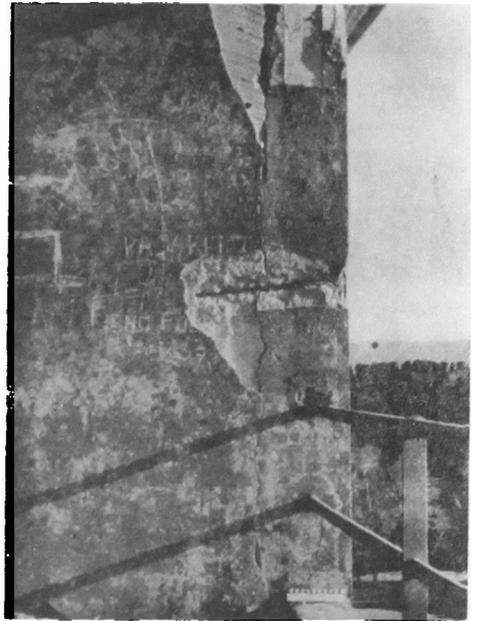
Falla de anclaje en la esquina de dos muros. Terraza, extremo poniente. Hospital Regional de Valdivia.
